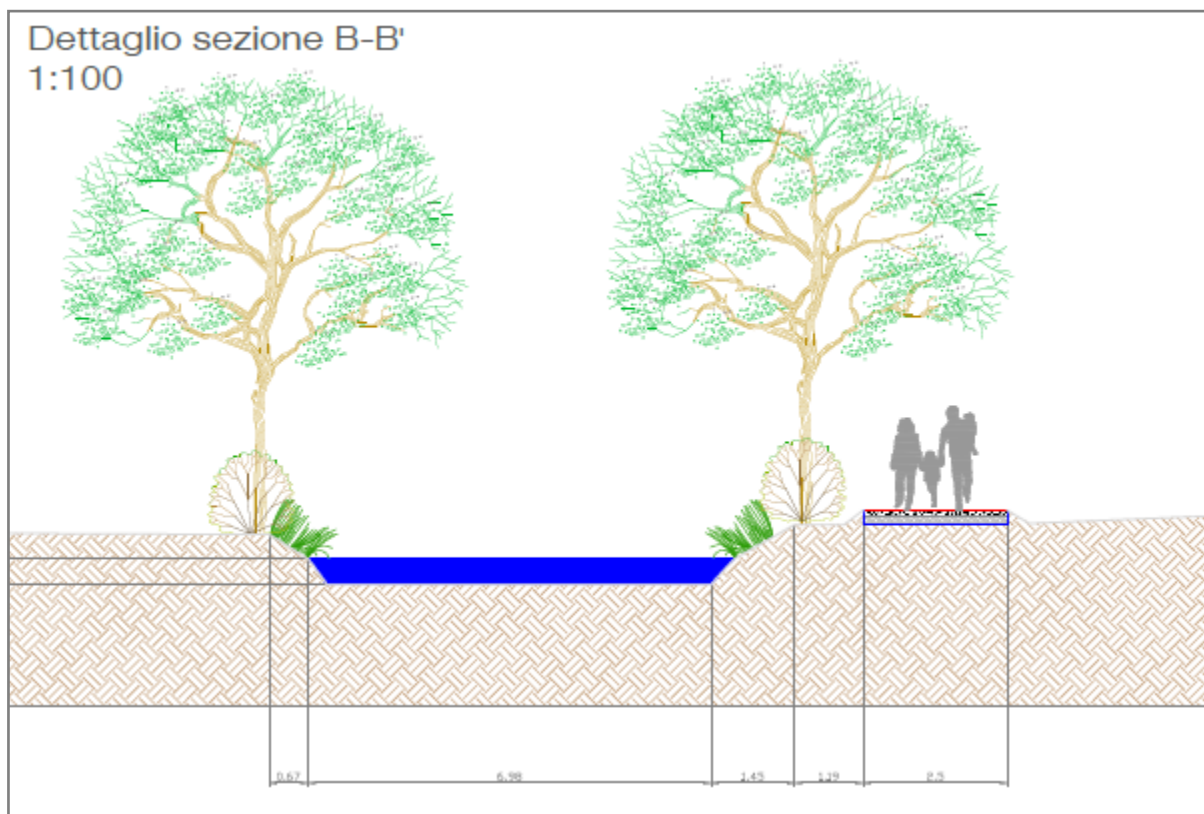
Sezione tipo della riprofilatura di alcuni tratti spondali
